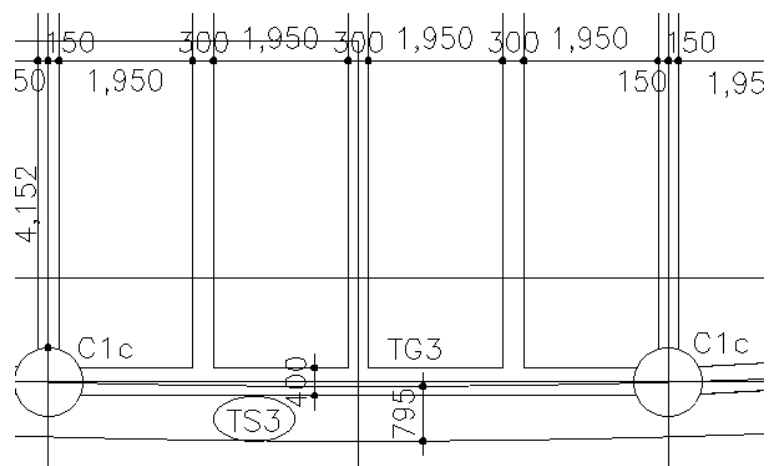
Extrait de la vue en plan de la poutre principale TG3
